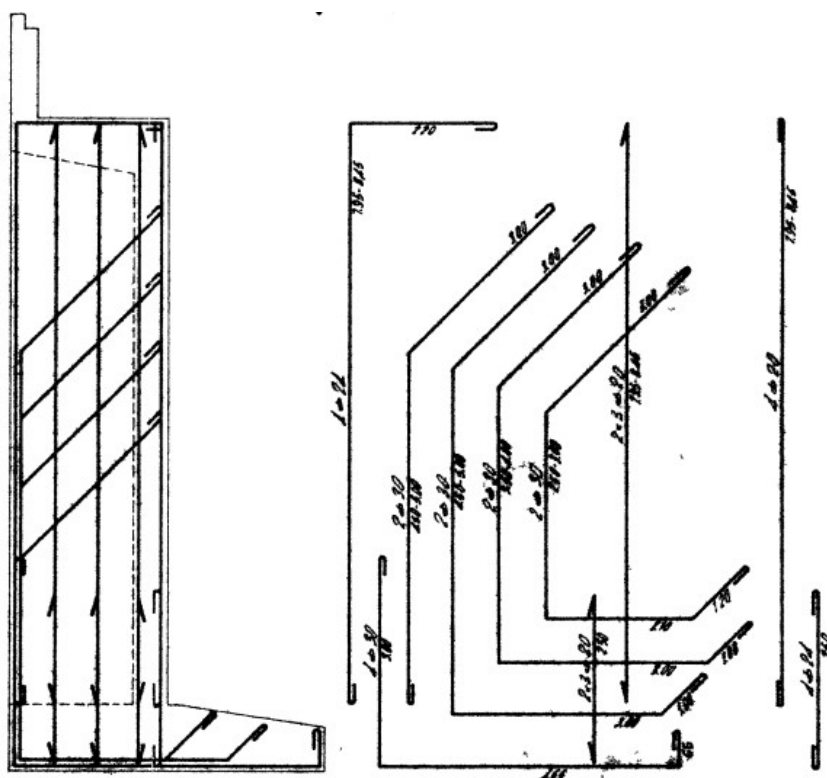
Documento as-built “Sottovia Interconnessione 1 dell’autostrada A14 al km 14+232” – Sezione trasversale con armature contrafforti.
